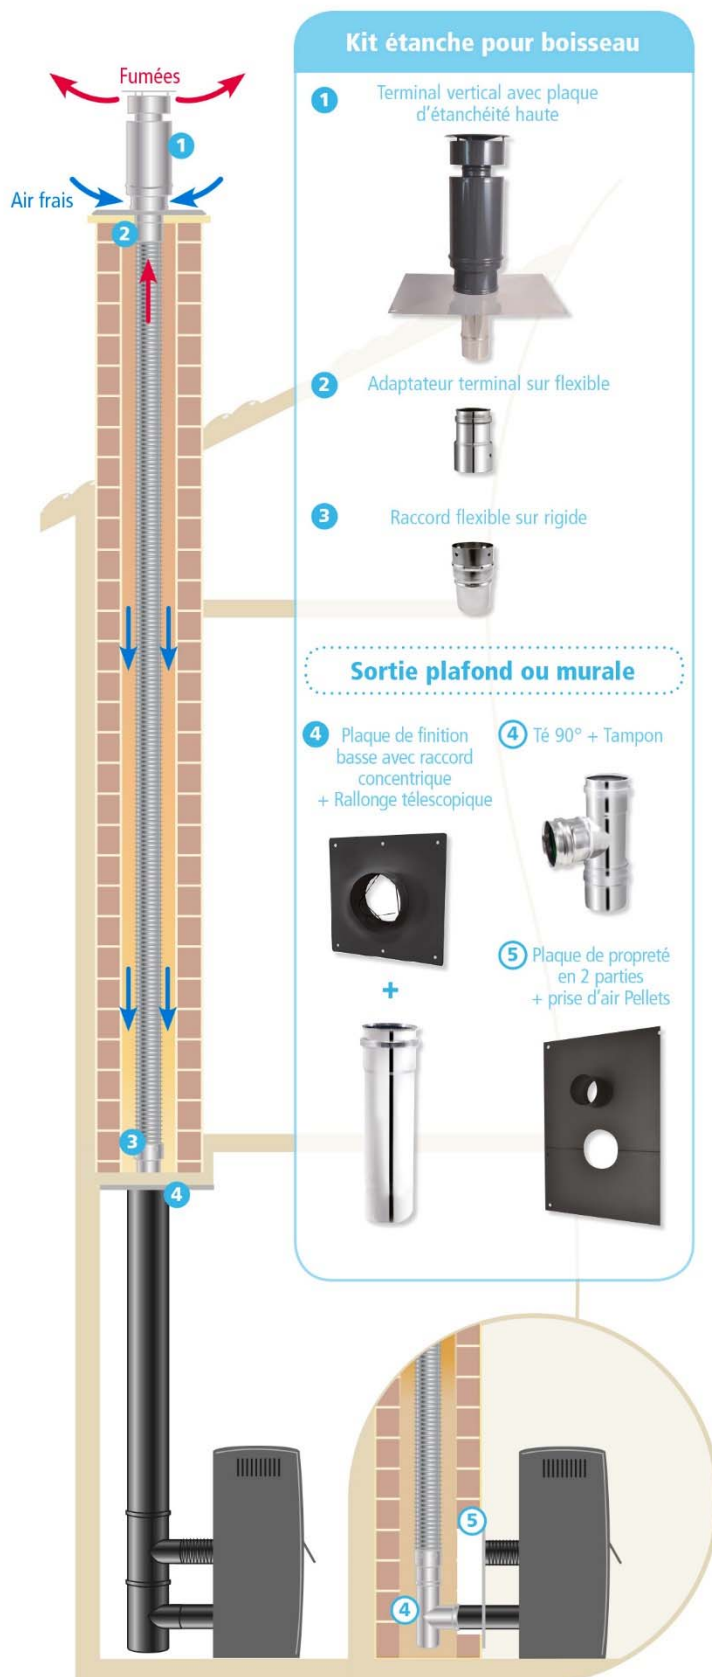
Schémas de principe avec réutilisation d'un conduit existant avec conduit Flex lisse ou POLYSTAR
